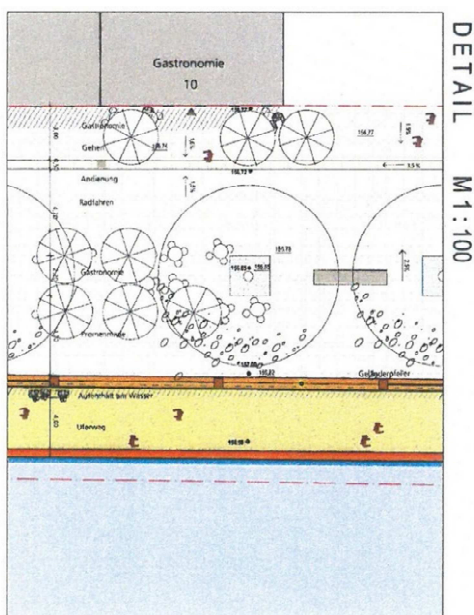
Entwurfsplan für den Umbau der Unteren Neckarstraße zur Promenade mit einer Vielzahl neuer Baumstandorte.
